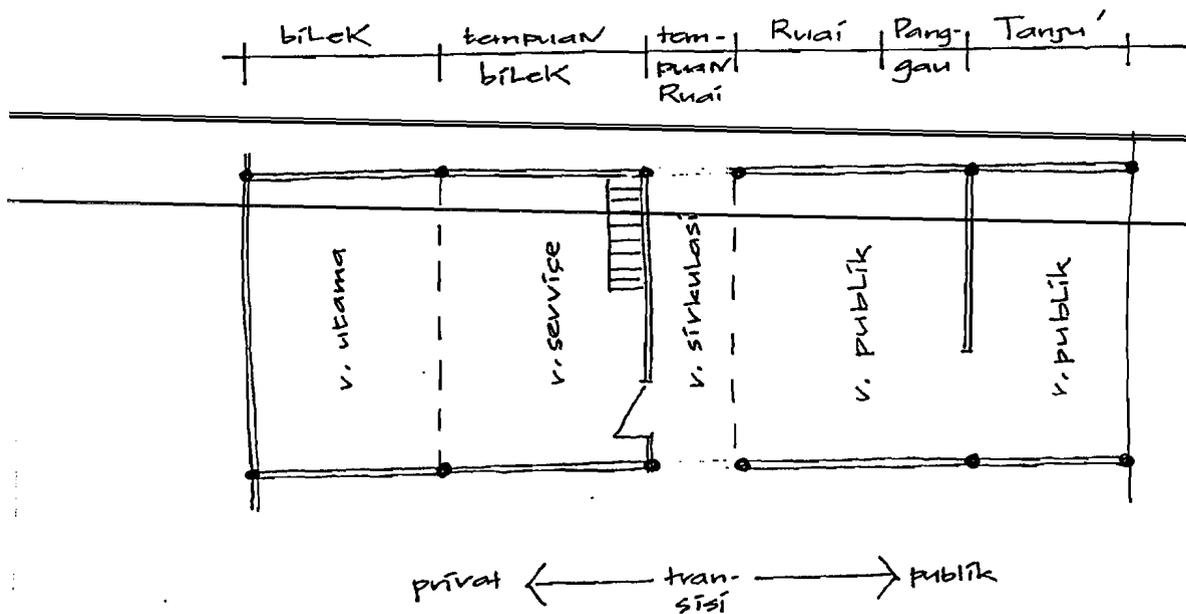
Alternatif Penerapan Tata Ruang Dalam pada TPKL
